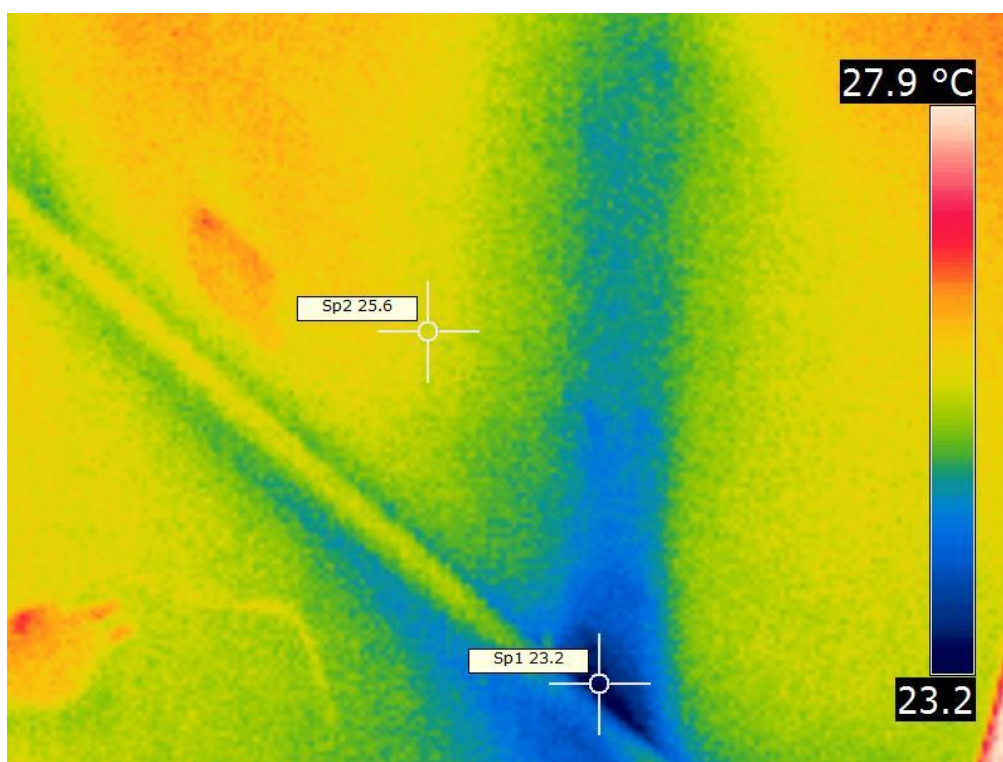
Проникновение холодного воздуха в местах сопряжения перекрытия первого этажа с несущей стеной здания
